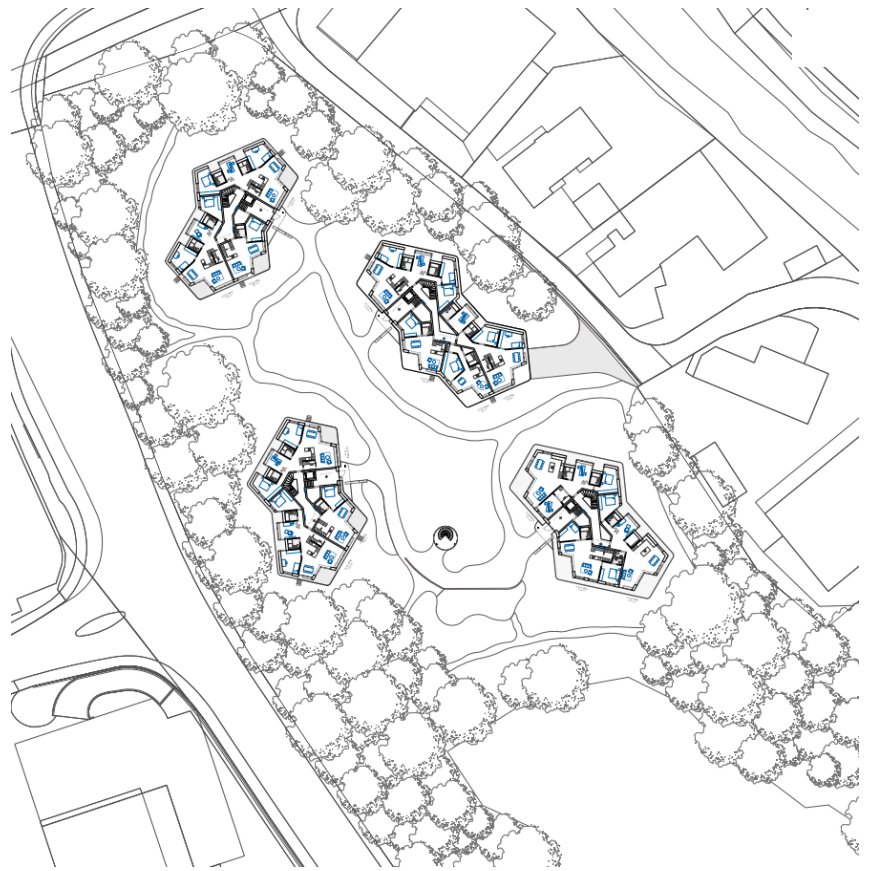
Grundriss Richtprojekt (Atelier 5 Architektur und Planung AG)
